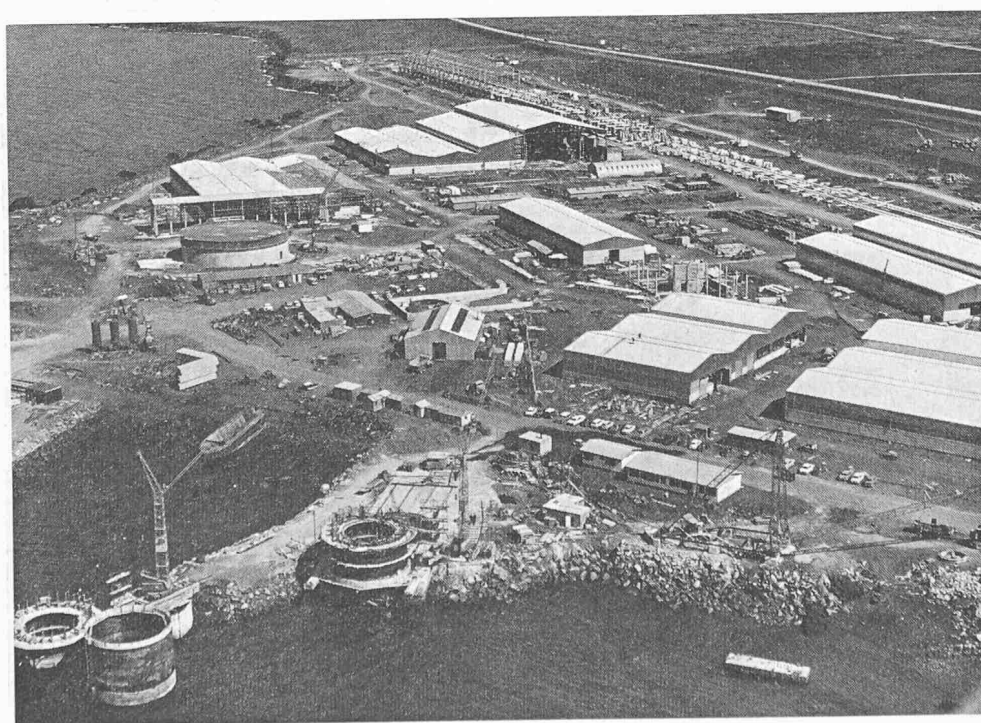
Für die Bauten der Hilfsbetriebe wurden äusserlich sehr ähnliche Konstruktionen angewendet
